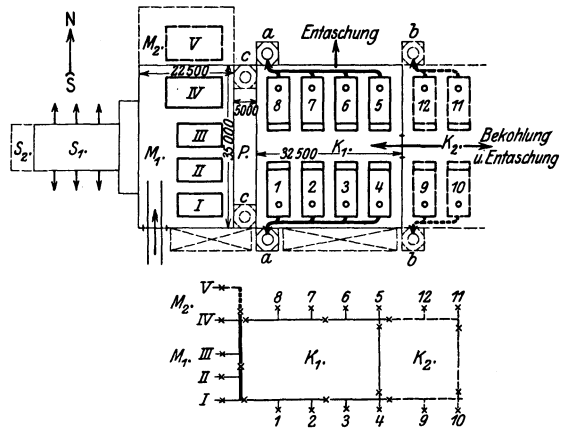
Gesamtdisposition eines Kraftwerkes mit Rohrplan. Maschinenlängsachsen senkrecht zu Kessellängsachsen.
